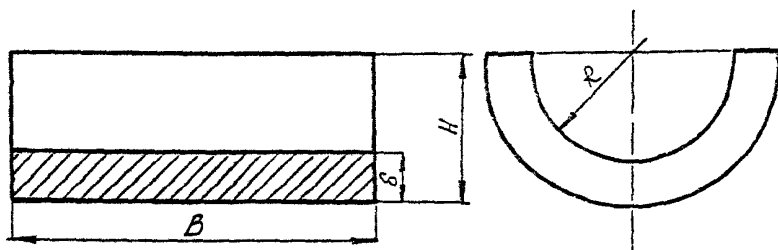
Конструкция стальной скобы-накладки для комбинированной сварки стыковых соединений стержней в горизонтальном
